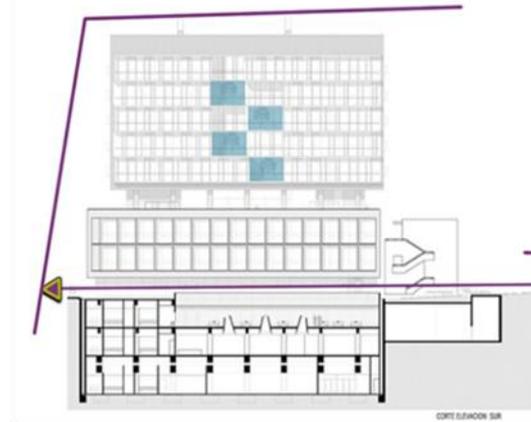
Aperturas temporales del complejo académico PUCP, (archdaily.pe)
